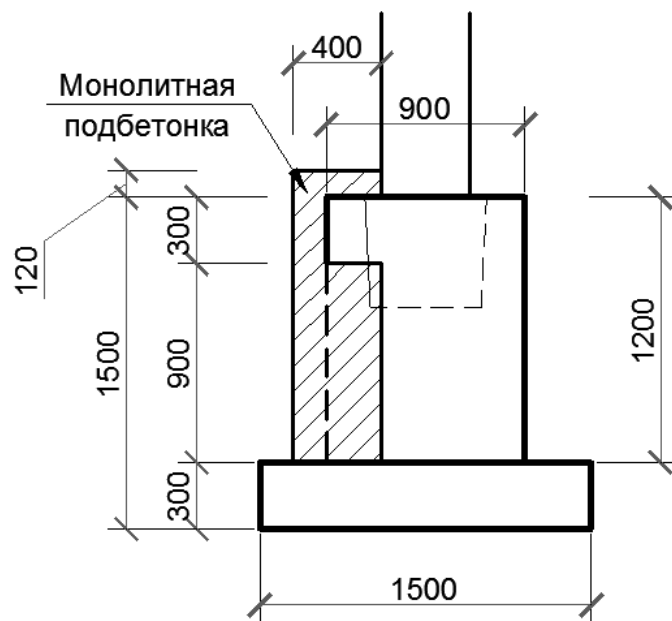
Размеры сборного фундамента Ф1.1.1 под колонну.
